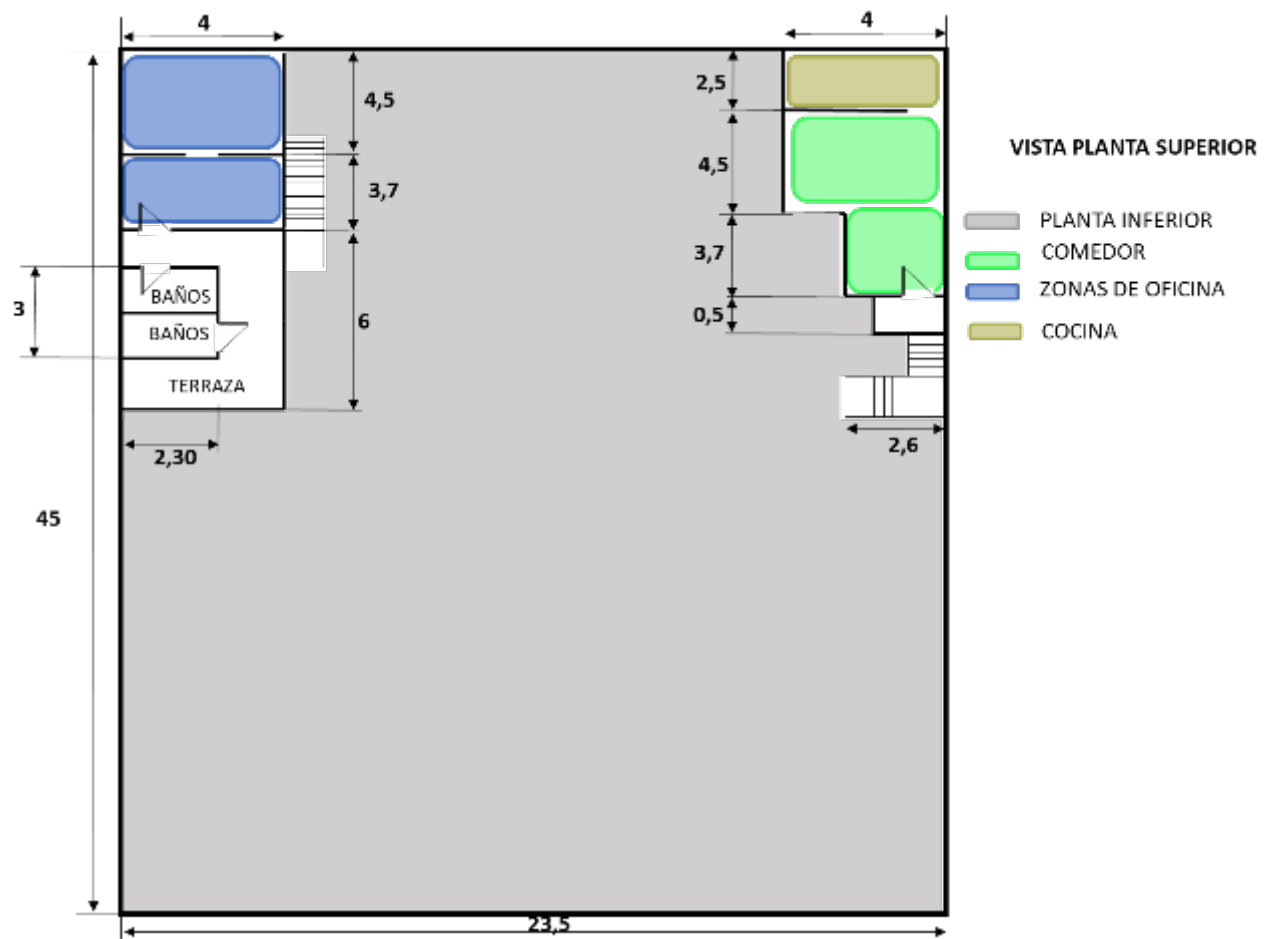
Layout propuesto de planta superior para la empresa VIA K, C.A
